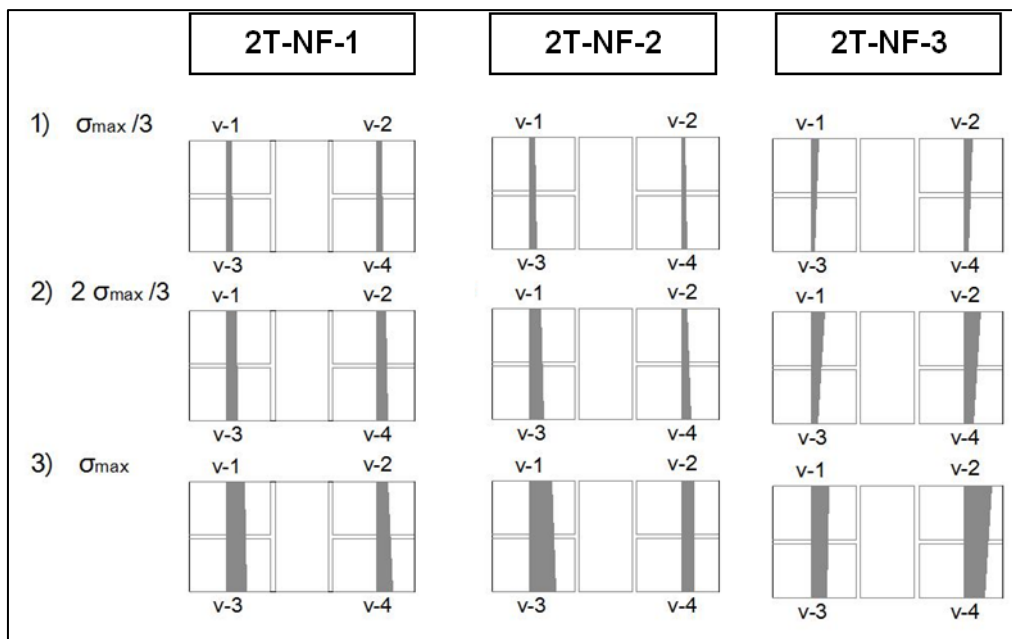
Muratura non esposta – Deformazioni rilevate dai trasduttori rappresentate sulla pianta dei provini
